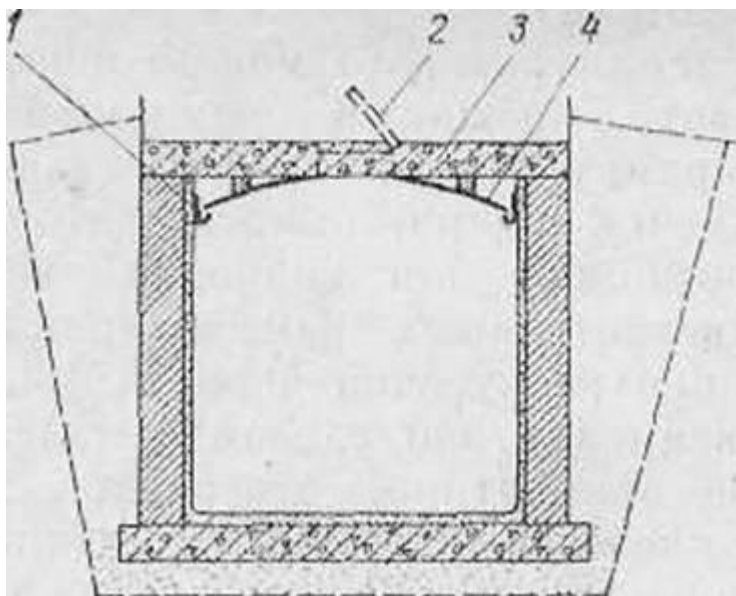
Отвод конденсата и капежа с потолка погреба: 1 – желоб; 2 – люк; 3 – перекрытие; 4 – зонт из кровельного железа
